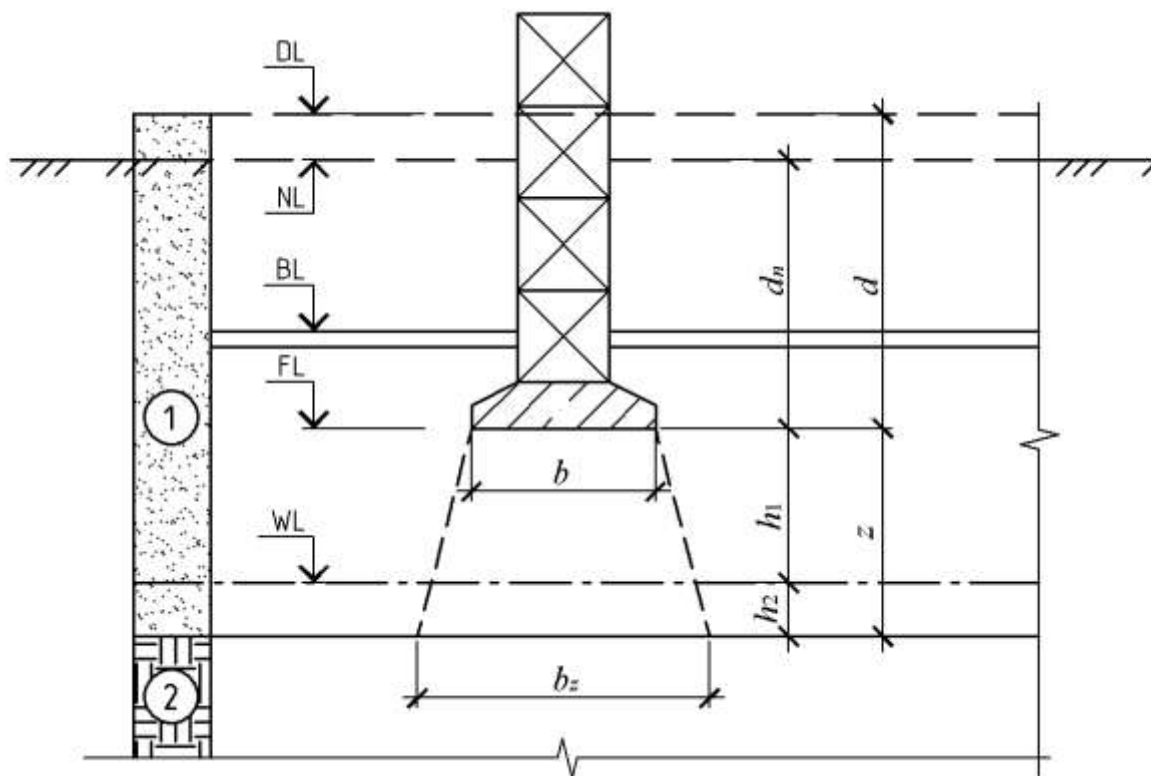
Расчетная схема для проверки расчетного сопротивления по подстилающему слою грунта: 1 - грунт верхнего слоя; 2 - грунт подстилающего слоя
